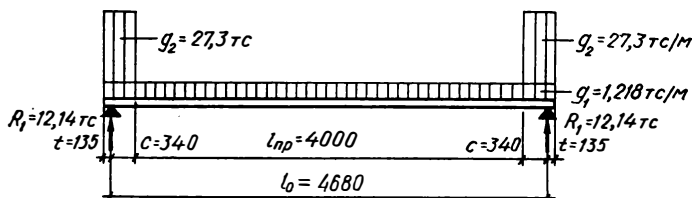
Расчетная схема фундаментной балки для 1-го случая загрузки.
